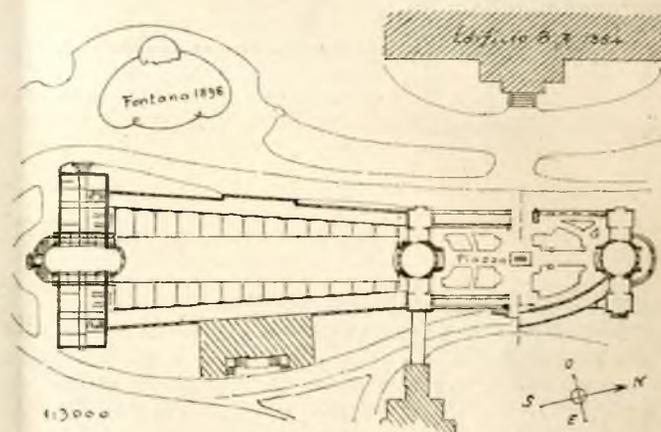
Planimetria del nucleo principale (Progetto Rita 2ª).
